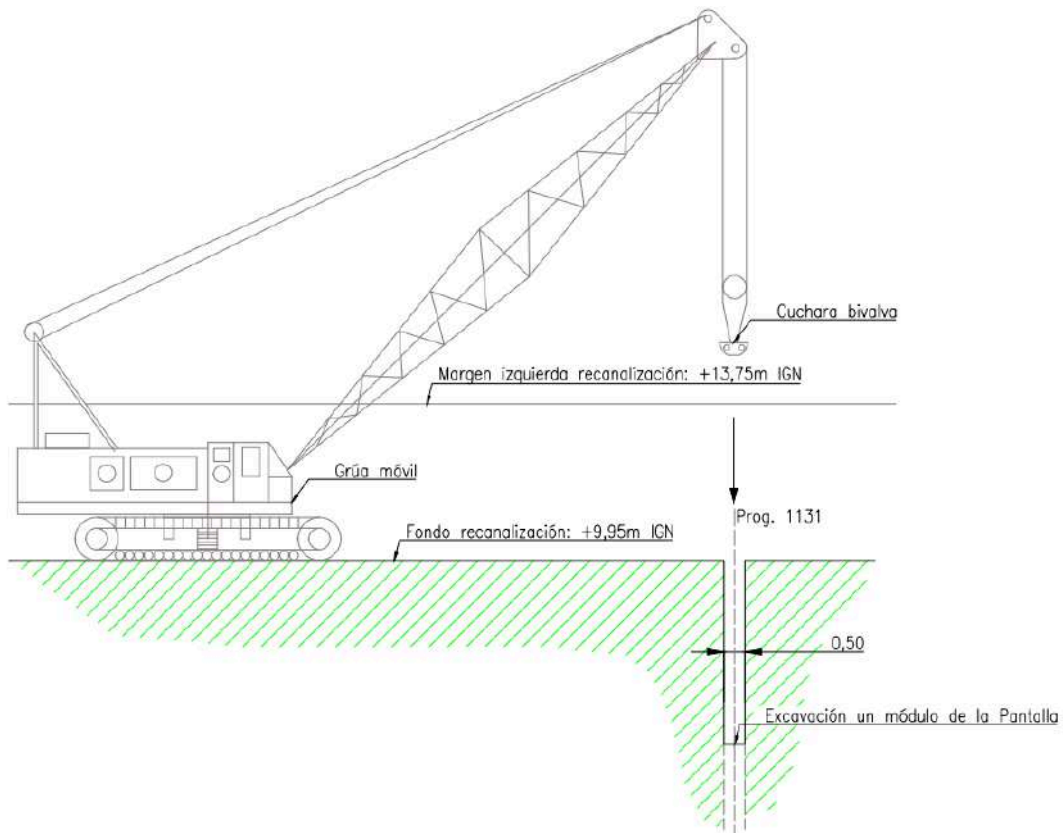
Corte longitudinal de la ejecución del muro colado en el tramo central. Fuente: Elaboración propia.
